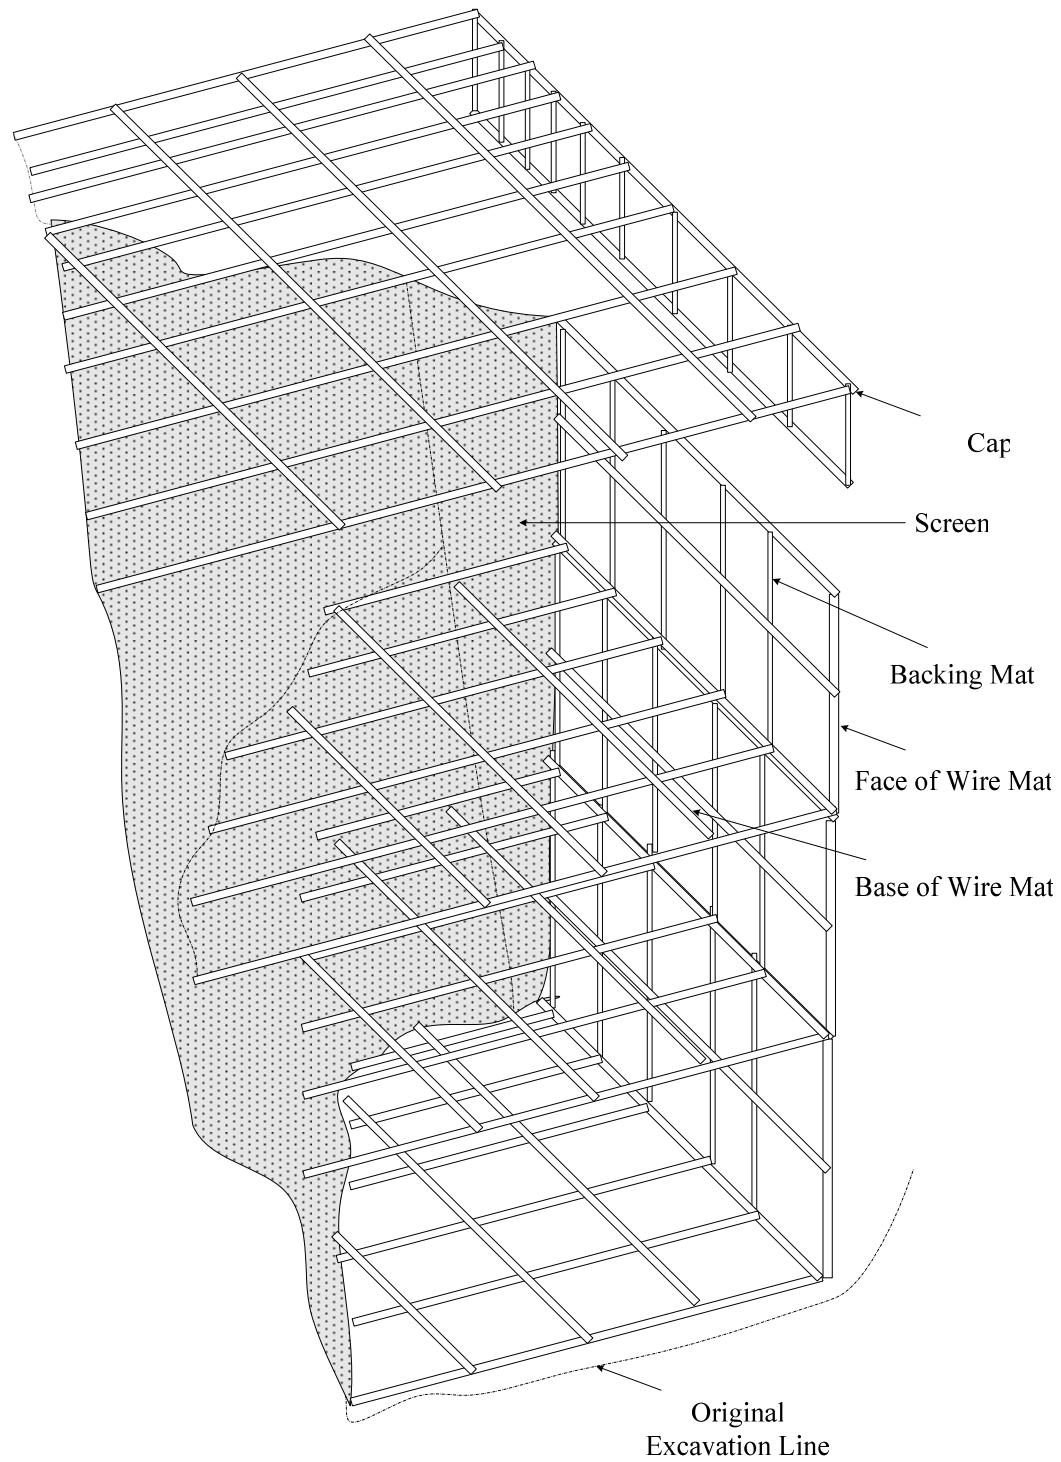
กำแพงกันดินแบบ Reinforced Earth (Reinforced earth wall)
